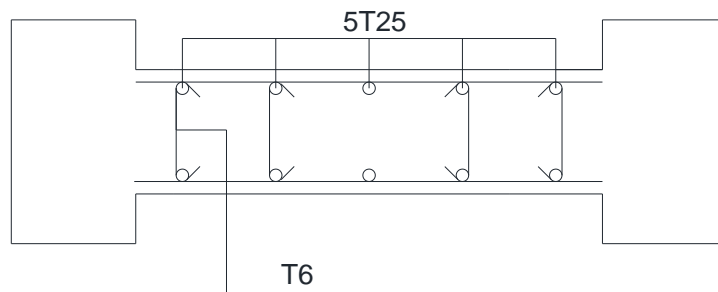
Schéma de ferrailage d'une voile (poutres noyées – plan irrégulier en élévation)
